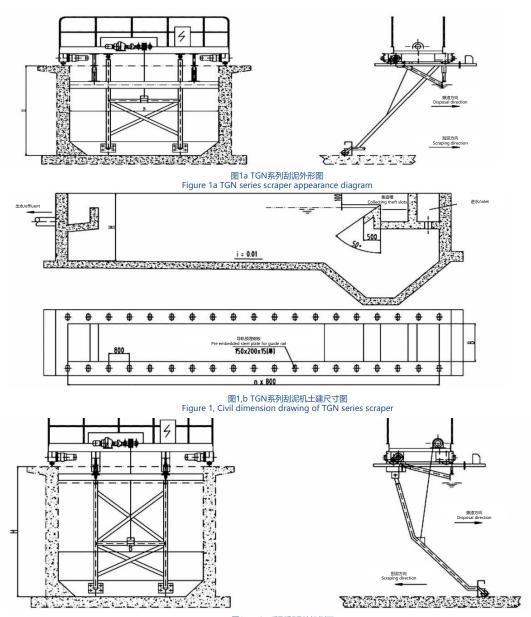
,a TGN系列刮泥外机侧面 Figure 2, side view of TGN series scraper external machine
